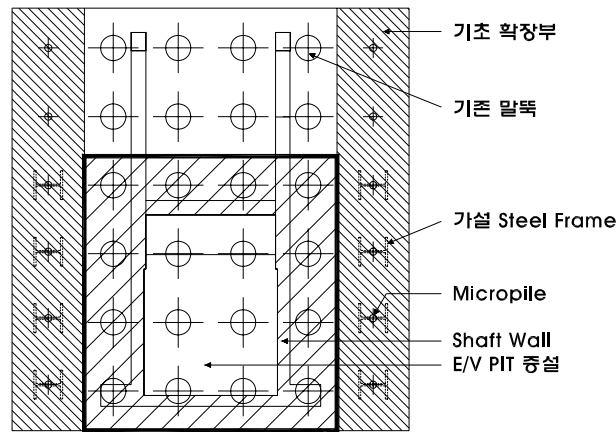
아파트 A동 엘리베이터 PIT 증설 시공 평면도
